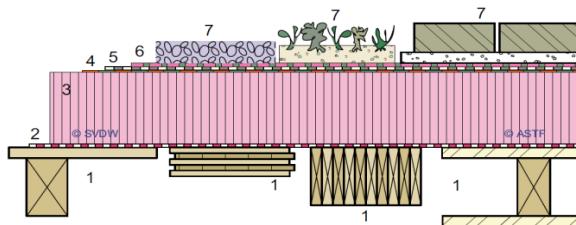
Nicht durchlüftete Konstruktion - Wärmedämmung auf der Tragkonstruktion [12]
